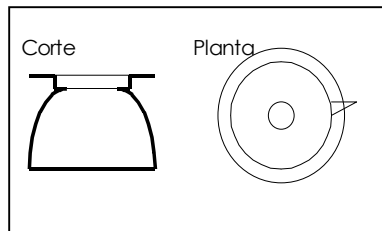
Planta y alzado de hábitat excavado en China, conocido como viviendas en saco. Neolítico Fuente: Loubes 1985, p.20
